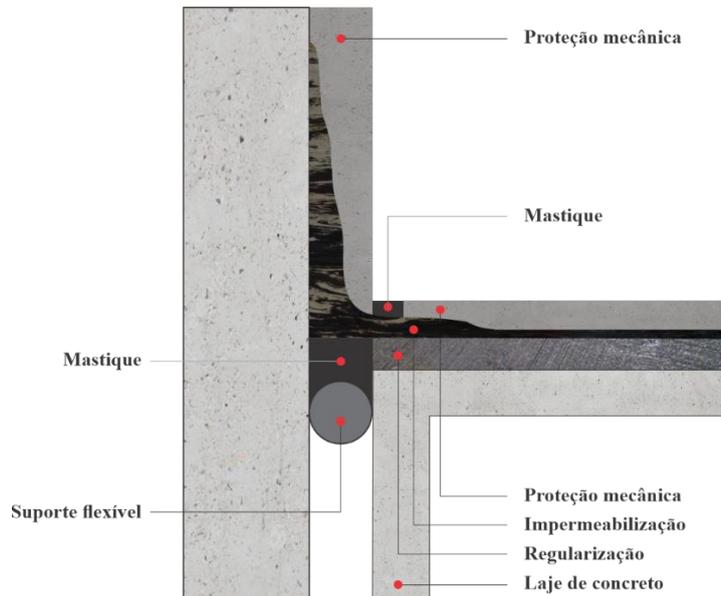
Detalhe alternativo de impermeabilização em junta de dilatação.
